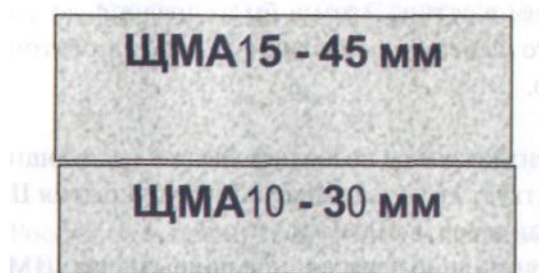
Конструкция «двойной вертикальный перевернутый слой»
